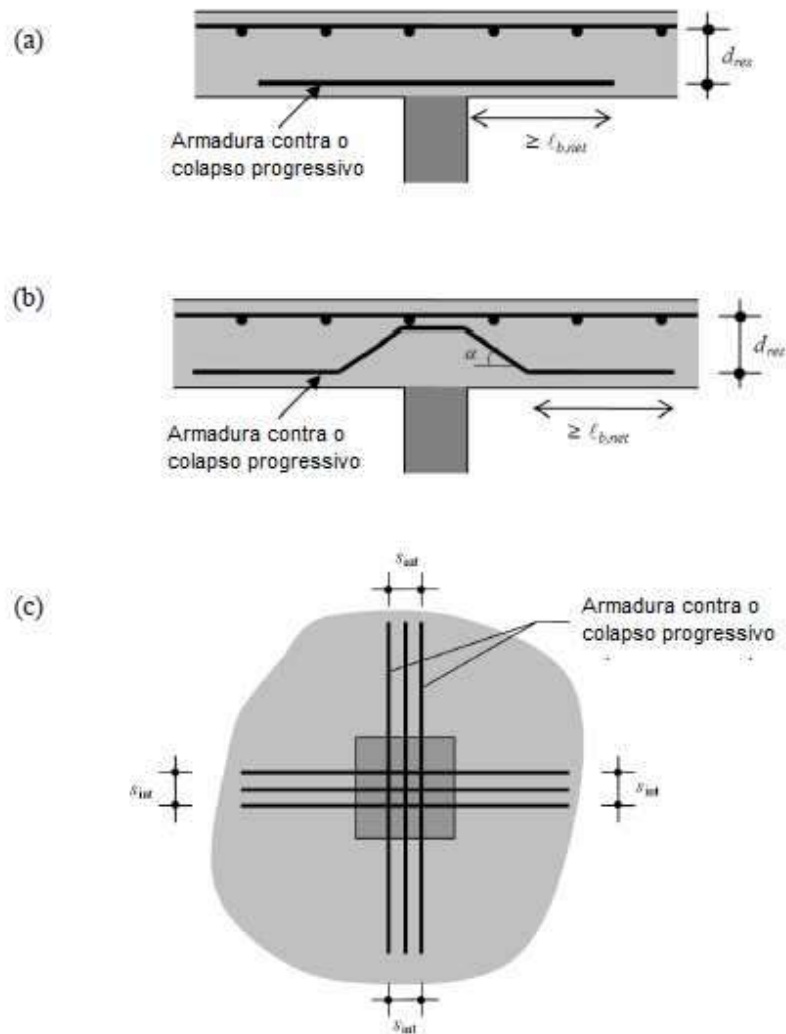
Esquemas de armadura para prevenção do colapso progressivo: a) barras retas; b) barras dobradas; c) disposição das armaduras em planta (adaptado de FIB, 2013)
